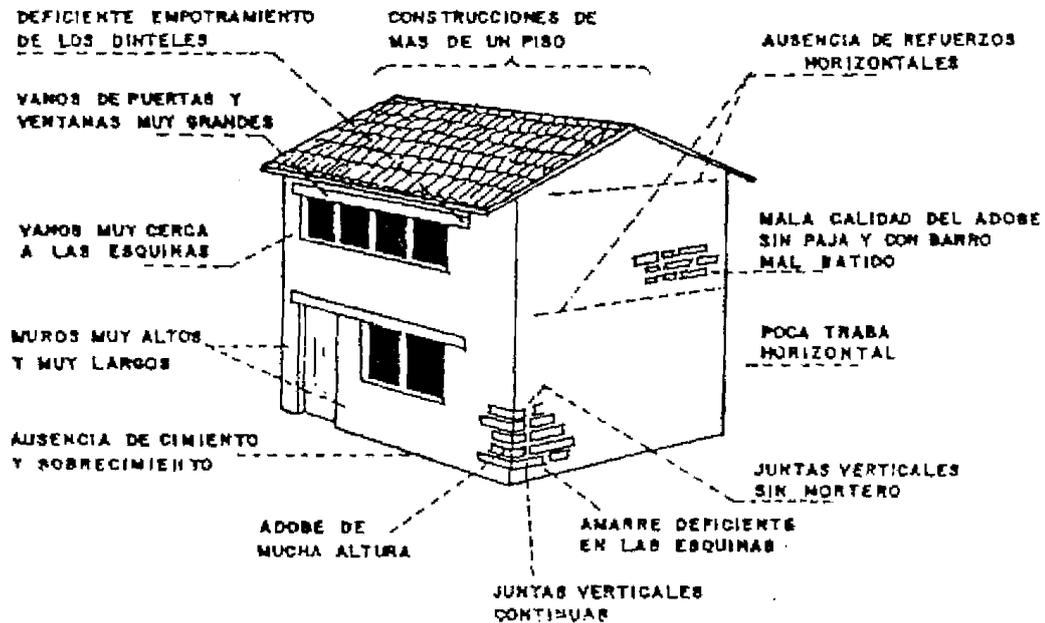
Esquema de las deficiencias en la construcción de viviendas con adobes.
